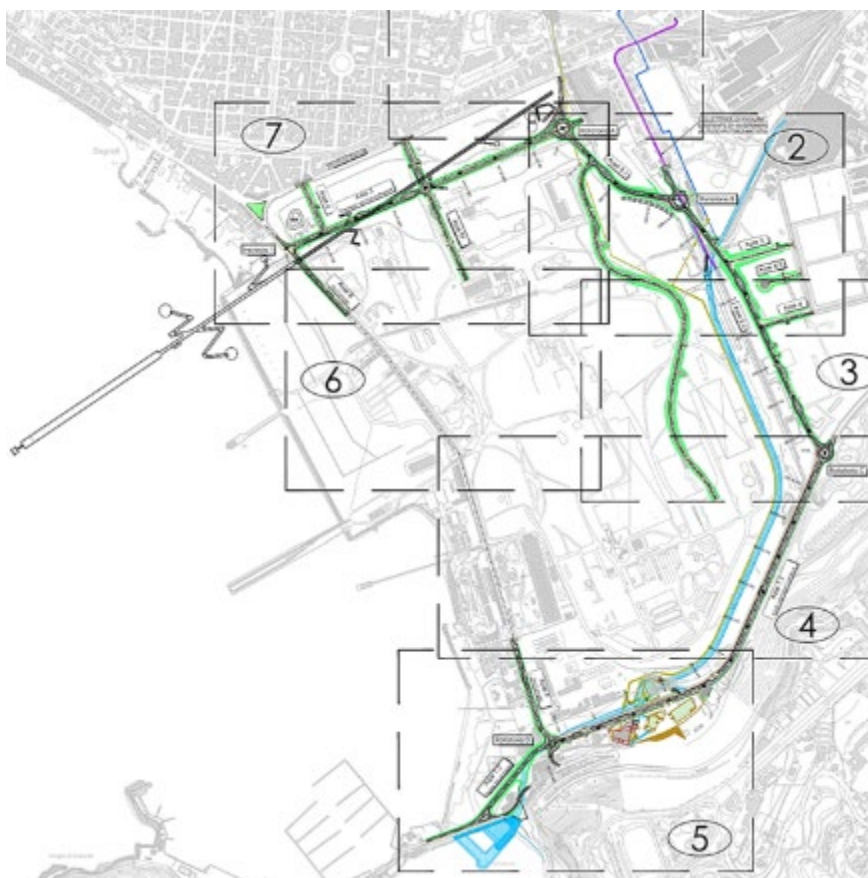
infrastrutture trasporti viabilità – Planimetria generale e quadro di unione
